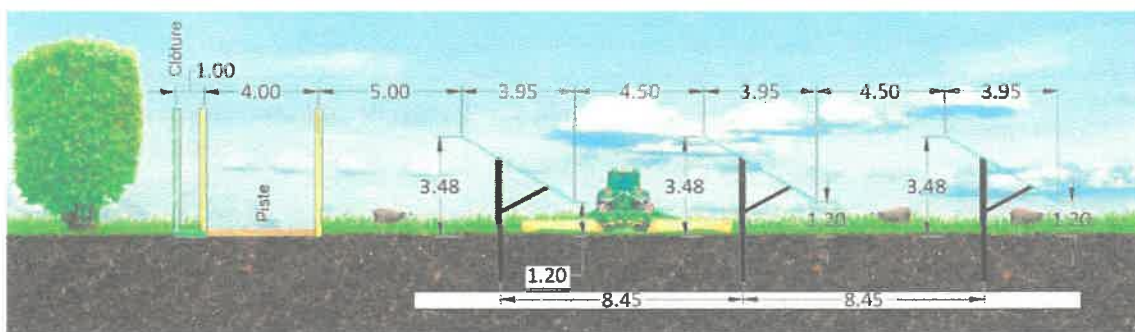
Coupe du dimensionnement de la zone nord du projet
